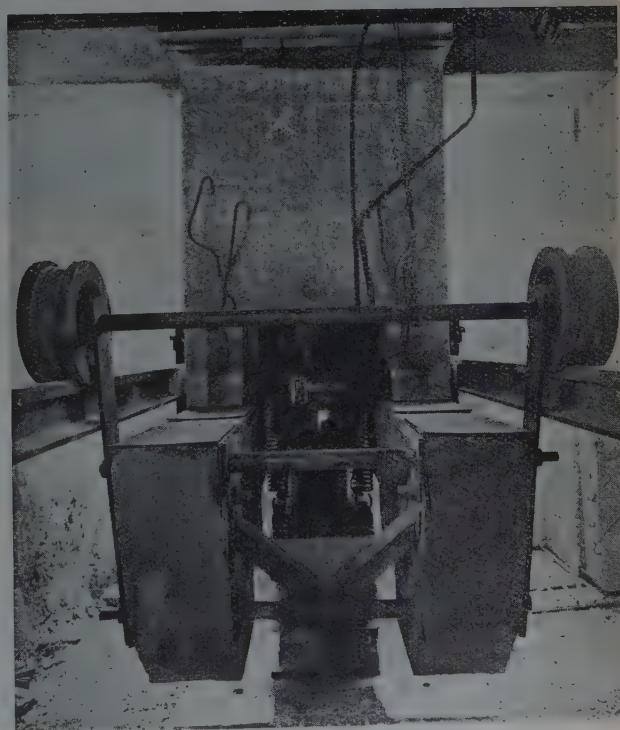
Dispositions en tête des poteaux extrêmes d'un long pan.
